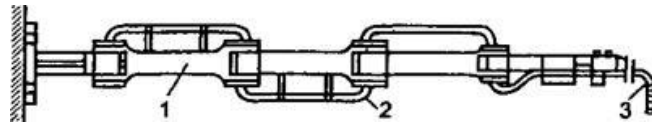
Маніпулятор для горизонтальної укладки бетону
